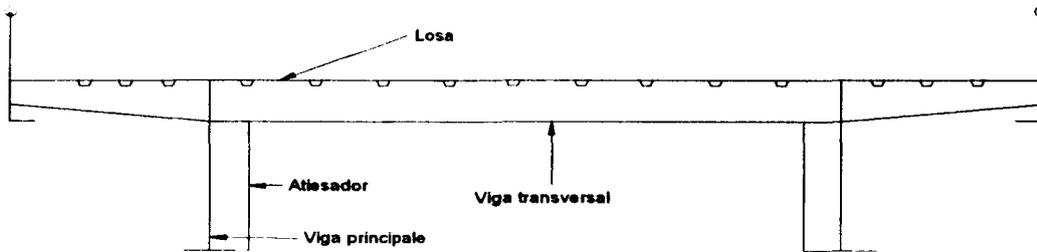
2 Puente moderno de acero, todos los miembros actuando como unidad
